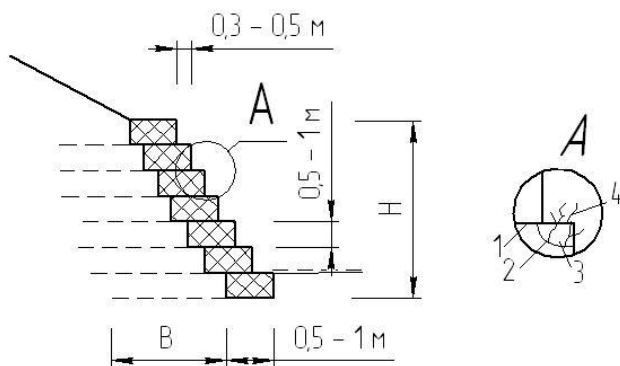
Поперечний профіль армогрунтової стінки:
